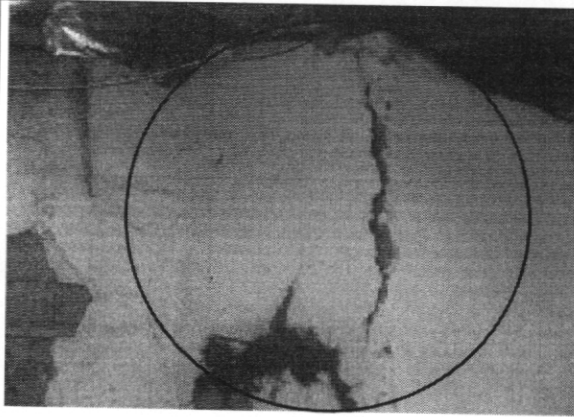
Desprendimiento de acabados en muros de fachada de interiores 18 a 22
